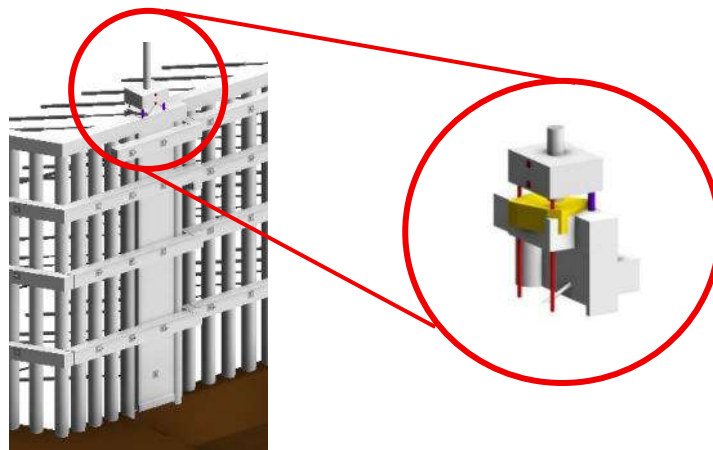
(a) Corte tipo: 5 níveis de ancoragem (Zona A) e Recalçamento do pilar adjacente
